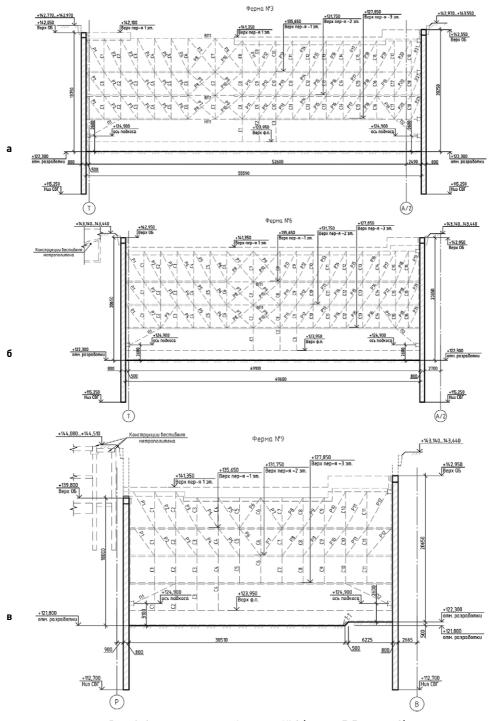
Схемы распорных ферм: $a - \mathbb{N}^2$ 3 (разрез 7-7 на рис. 3); $6 - \mathbb{N}^2$ 6 (разрез 4-4 на рис. 3); $B - \mathbb{N}^2$ 9 (разрез 2-2 на рис. 3) Fig. 4. Spacer truss schemes: a - no. 3 (section 7-7 in Fig. 3); 6 - no. 6 (section 4-4 in Fig. 3); B - no. 9 (section 2-2 in Fig. 3)
